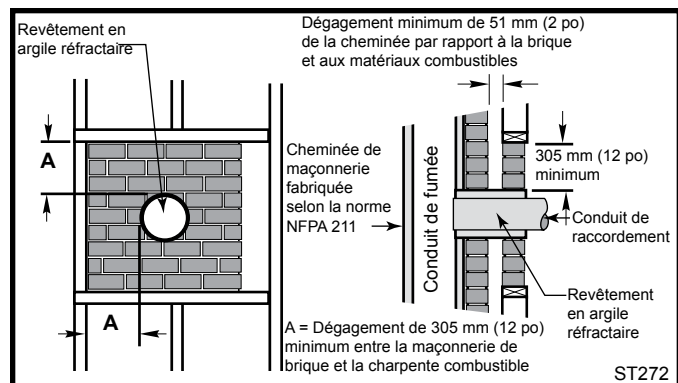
Traversée murale en maçonnerie avec conduit de raccordement à simple paroi.
